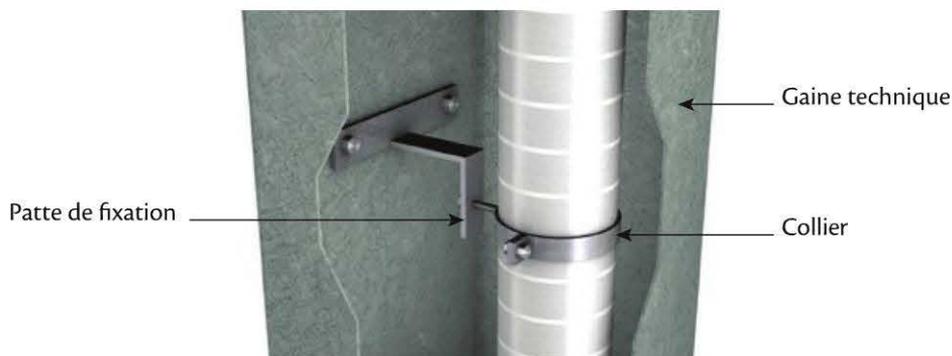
Exemple de fixation par étage d'une colonne en collectif
